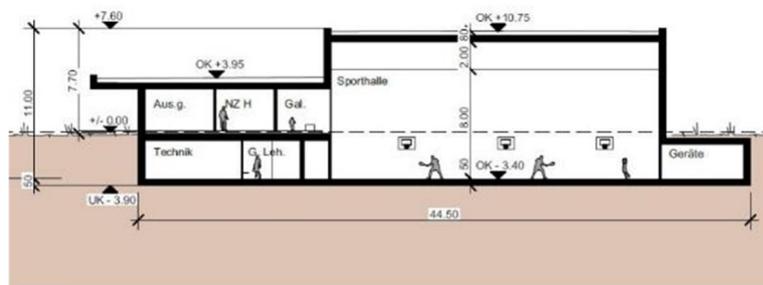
„versenkte“ Doppelsporthalle B | Disposition 1 - Querschnitt
